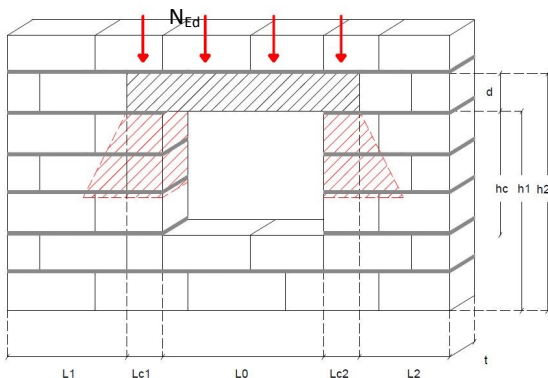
Configuration du mur avec ouverture : chargement mur et linteau
